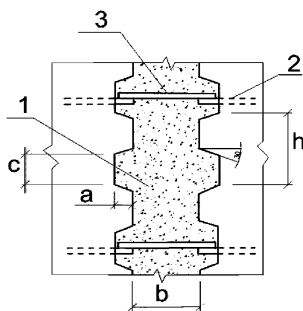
Вертикальный стык панельных стен на шпонках: 1 – бетон замоноличивания; 2 – выпуски арматурные; 3 – арматурные соединительные стержни
